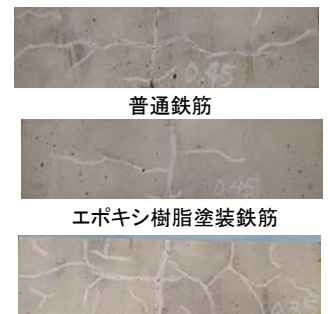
表面ひび割れ状況（曝露場所：南鳥島）
